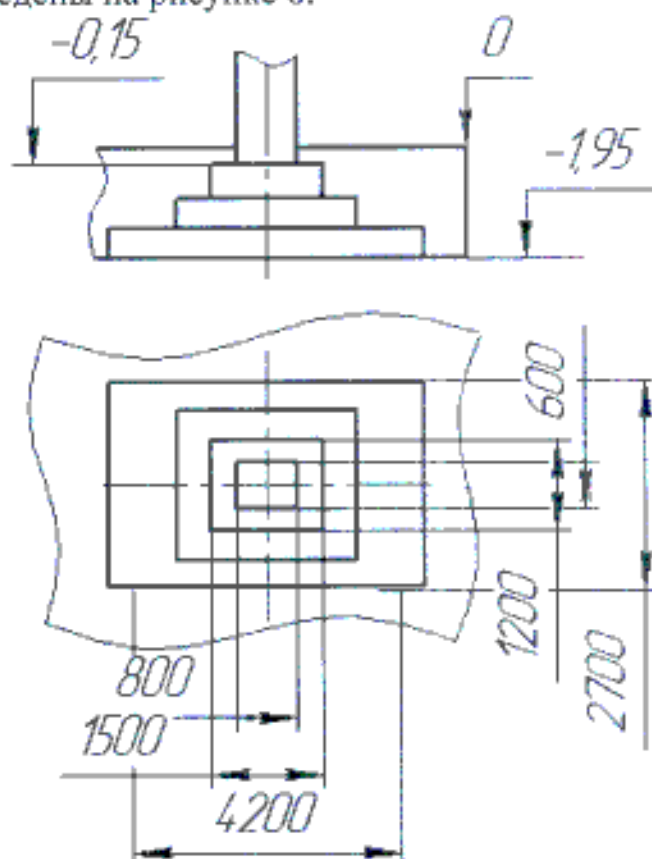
Фундамент под колонны серии КЭ-01-49
